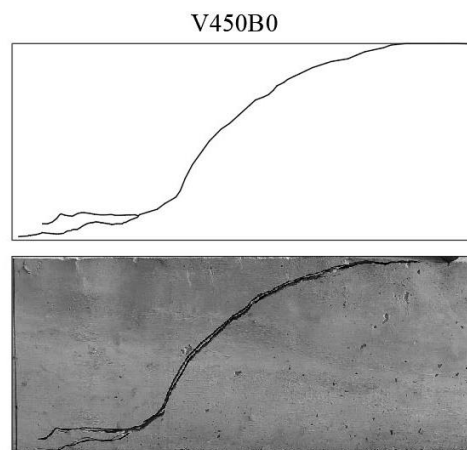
Padrão de fissuração da viga V450B0.
